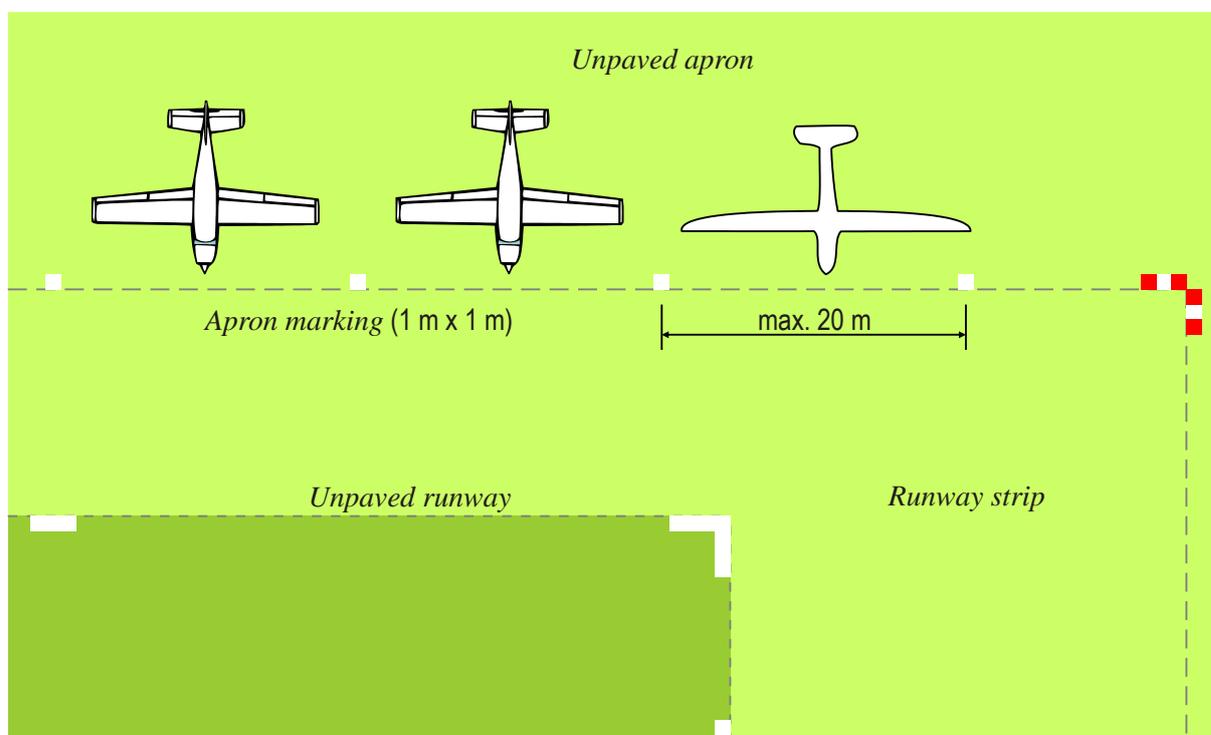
Delimitazione dall'area di traffico non pavimentata rispetto alla striscia di pista
